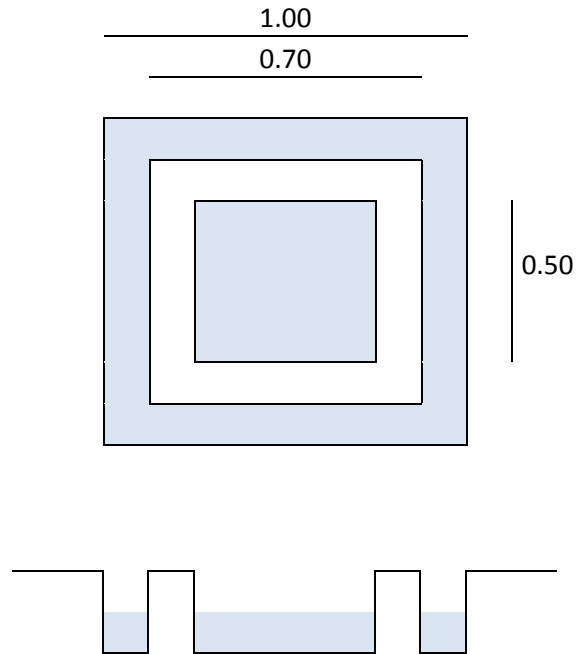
Vista de planta y perfil del hoyo de infiltración para laderas
